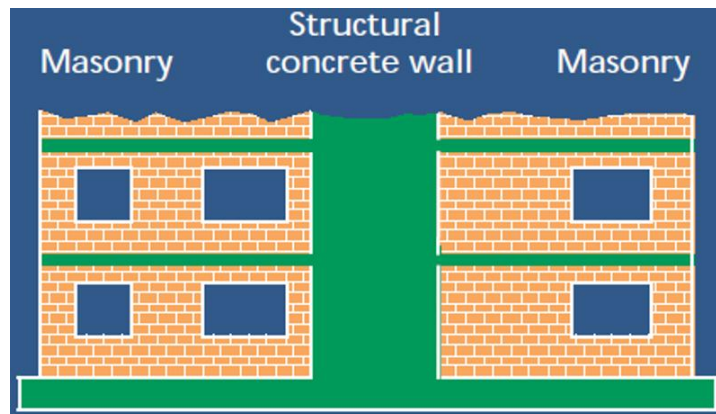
Edificios de mampostería con muros de hormigón armado
